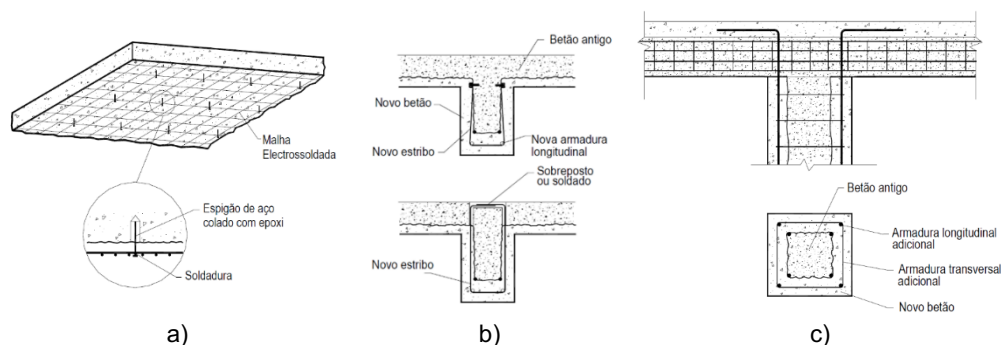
Reparação de a) lajes, b) vigas e c) pilares de betão (adaptado de [6])
